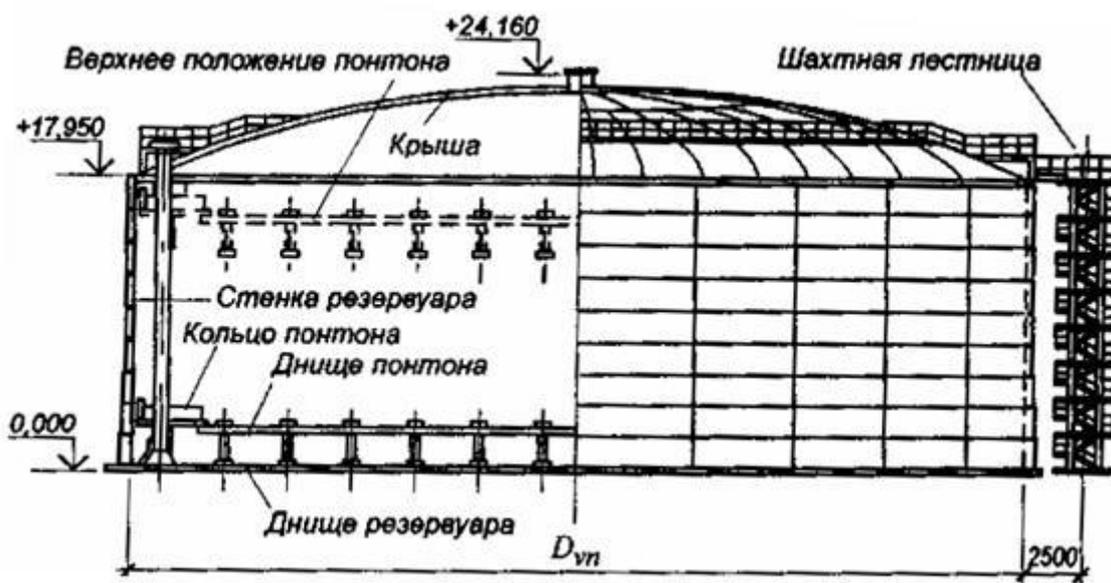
Вертикальный цилиндрический резервуар с понтоном РВСП
